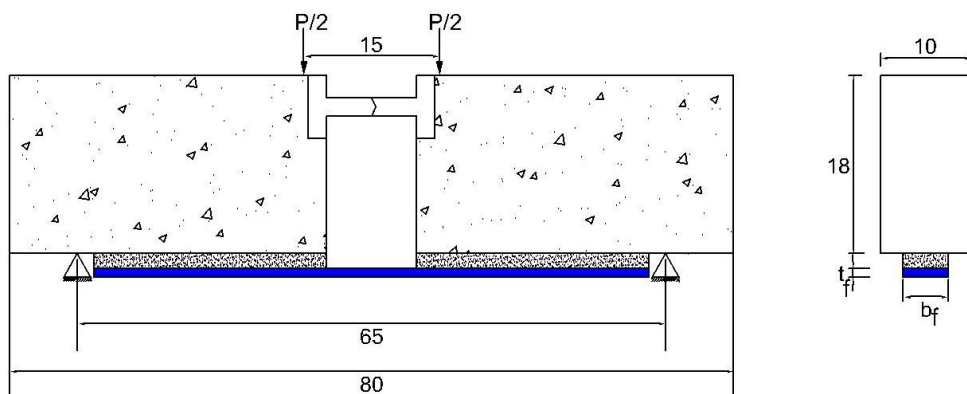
Geometría de las vigas ensayadas por López *et al.* (2011).
